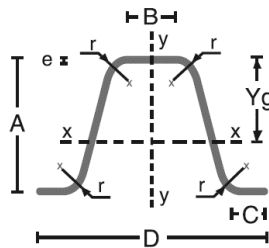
Perfiles que componen la estructura de cubierta, PGC perfil C.
